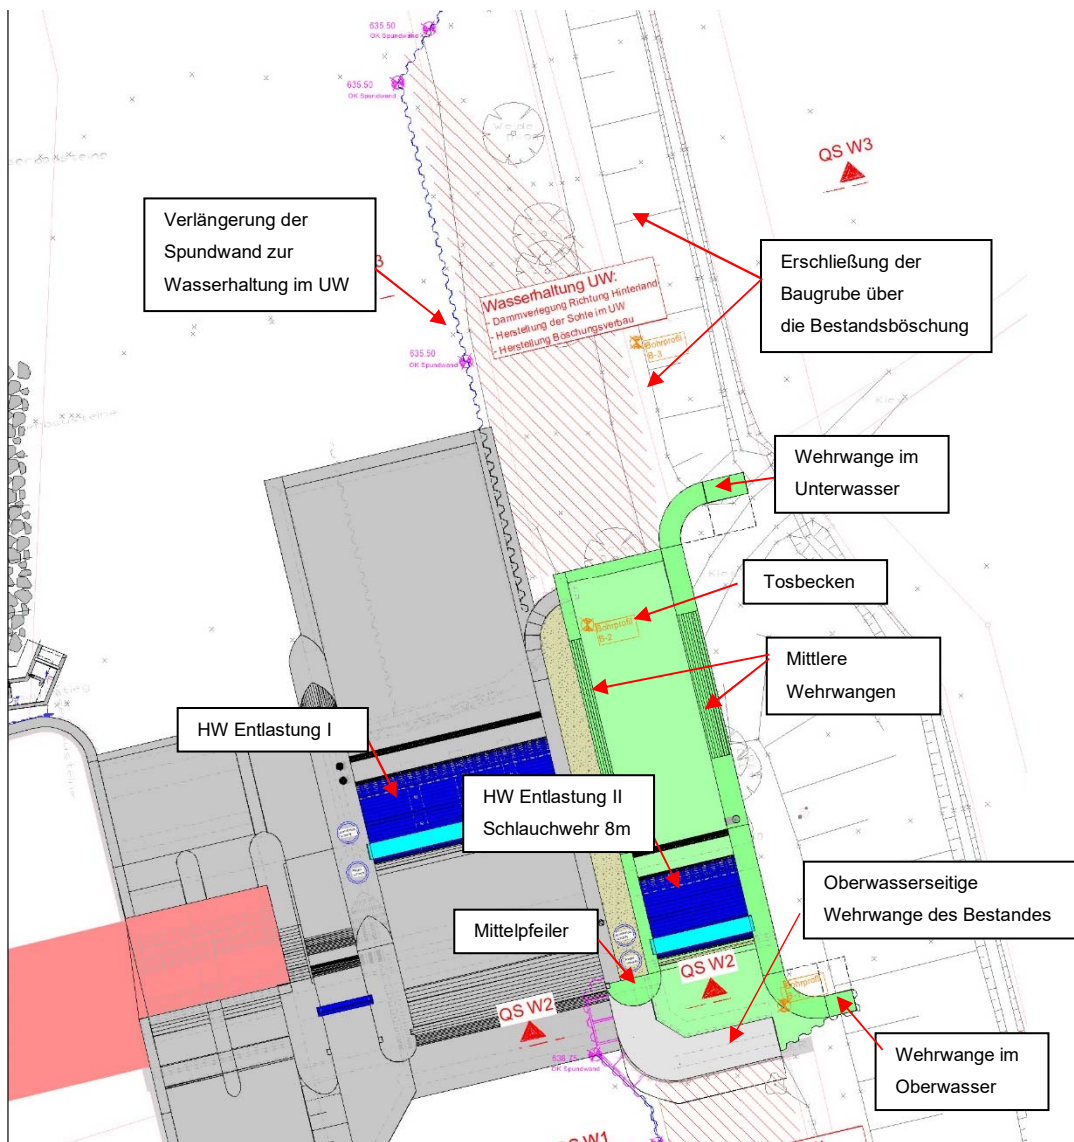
Lageplan / Neubau HW Entlastung II - Wasserhaltung
